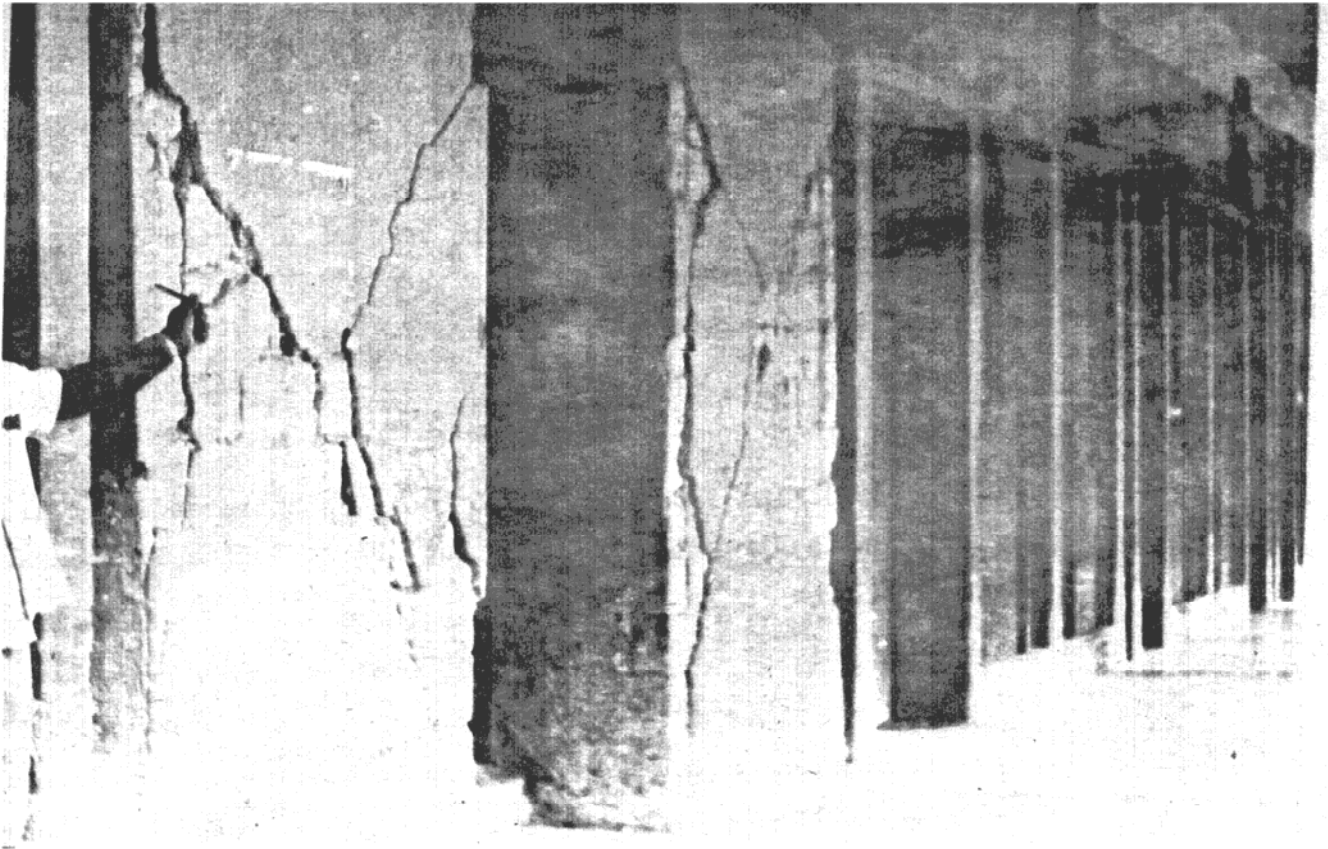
c. Pilón. Grietas grandes y profundas en paredes.
